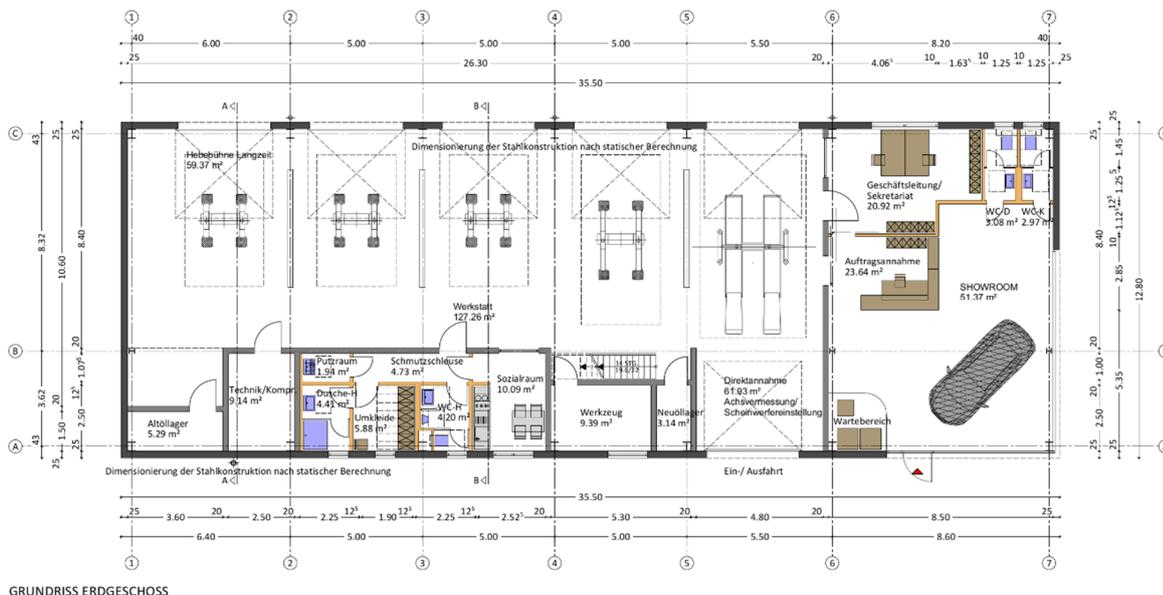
Grundriss Bauvorhaben /30/, ohne Maßstab
